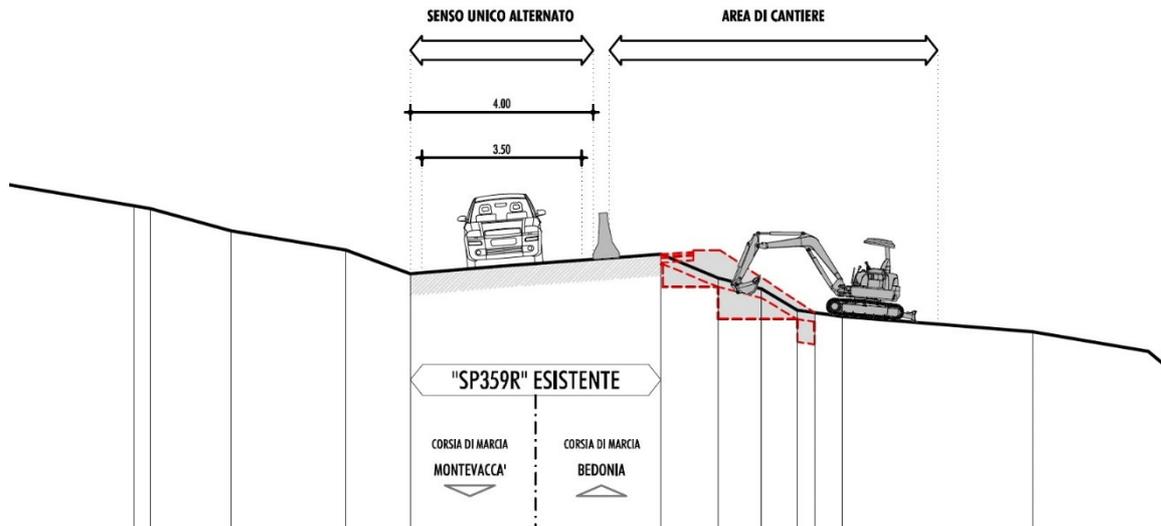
TRATTO 2, FASE 2: TRAFFICO SU CORSIA DI VALLE (ESTRATTO DALL'ELAB. PD.04.04)
